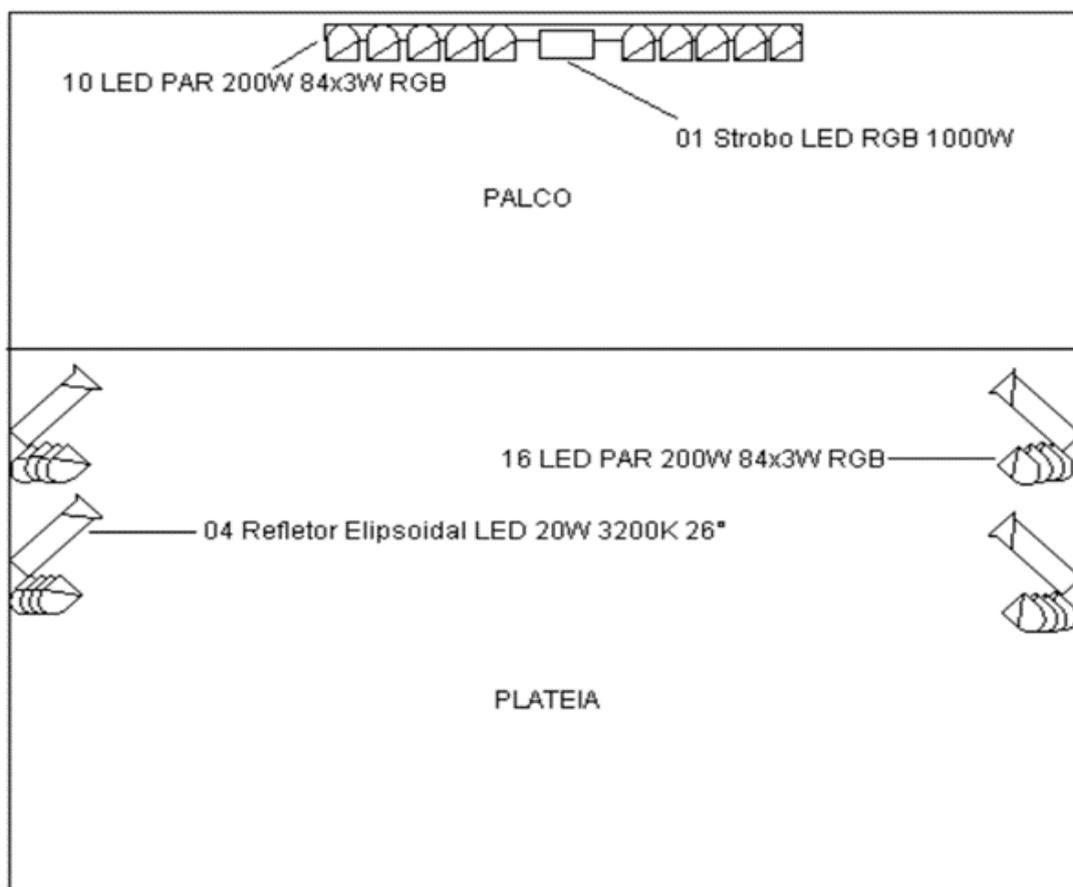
Planta baixa de equipamentos de iluminação cênica
